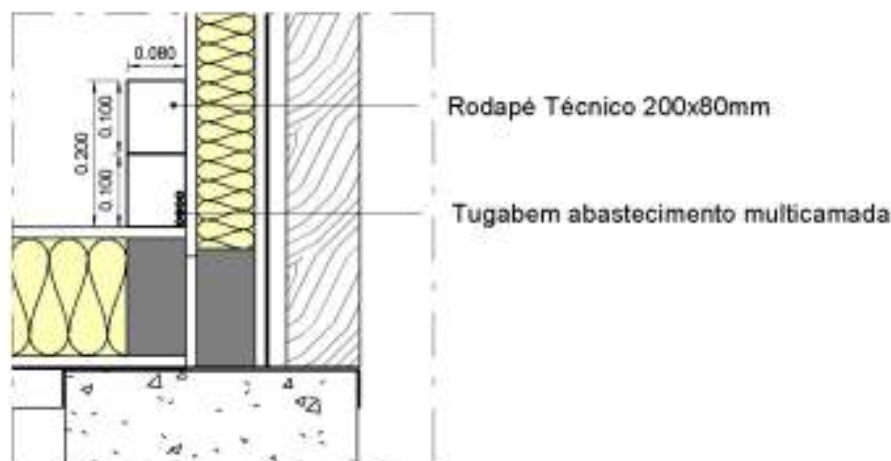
Pormenor do rodapé técnico para passagem da tubagem de abastecimento.
